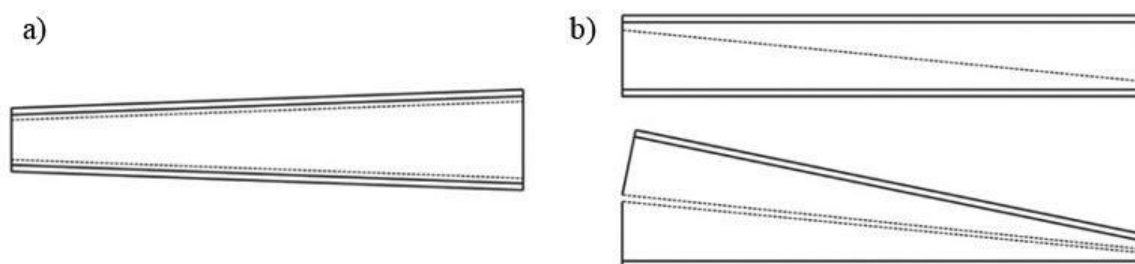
Fabrico de elementos em I de secção variável. a) Soldadura de chapas; b) Corte e soldadura de elemento laminado (Canha, 2012).
